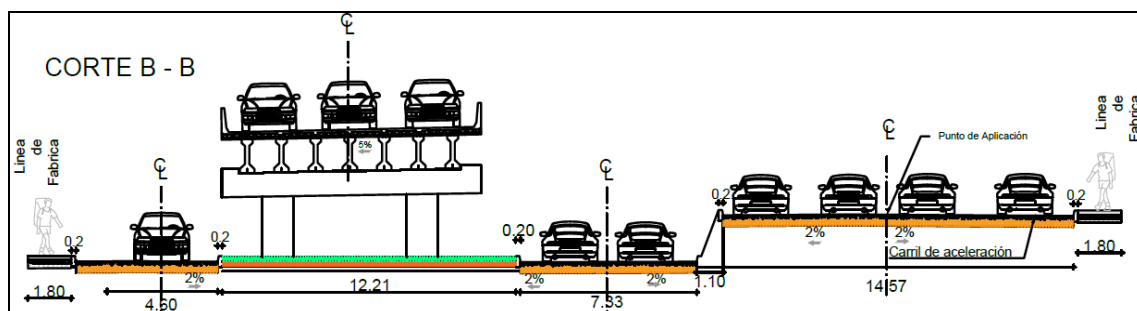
Sección típica Autopista Elevada, Distribuidor Gapal
